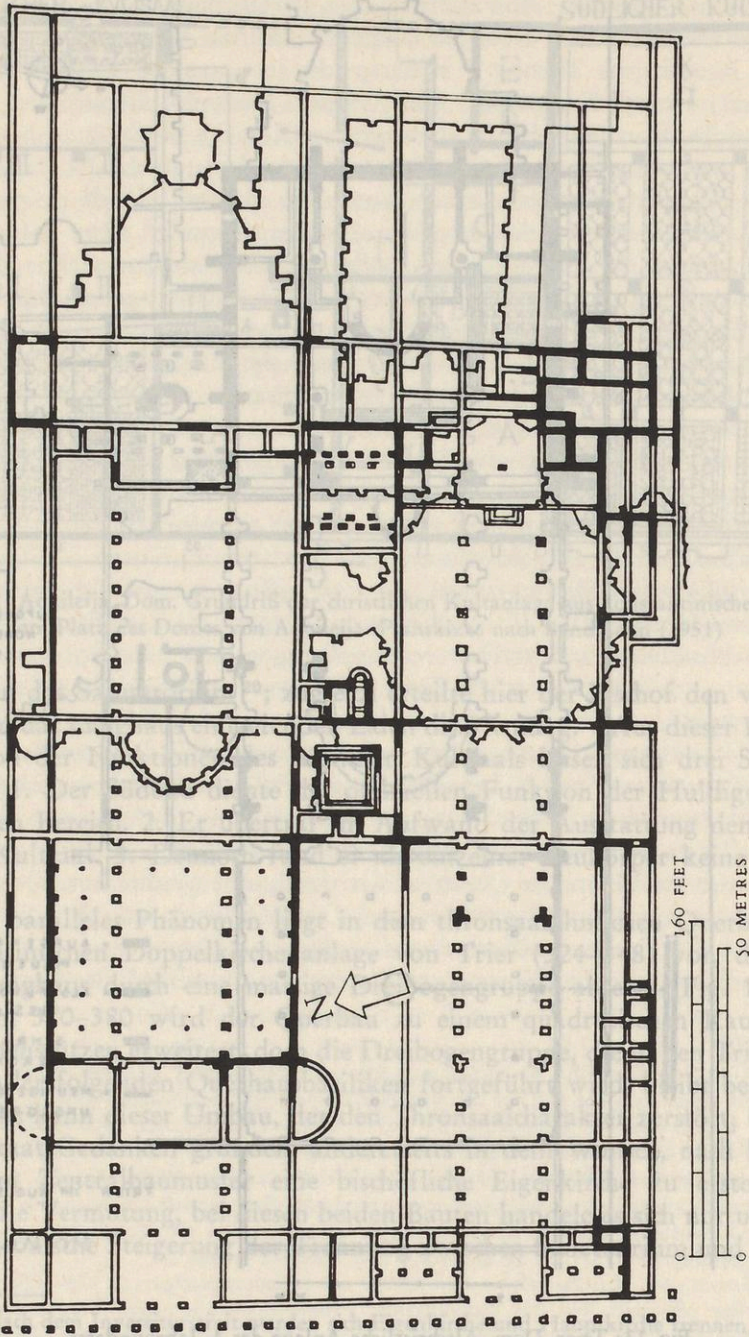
Trier, Dom. Grundriß nach Krautheimer (1965)
